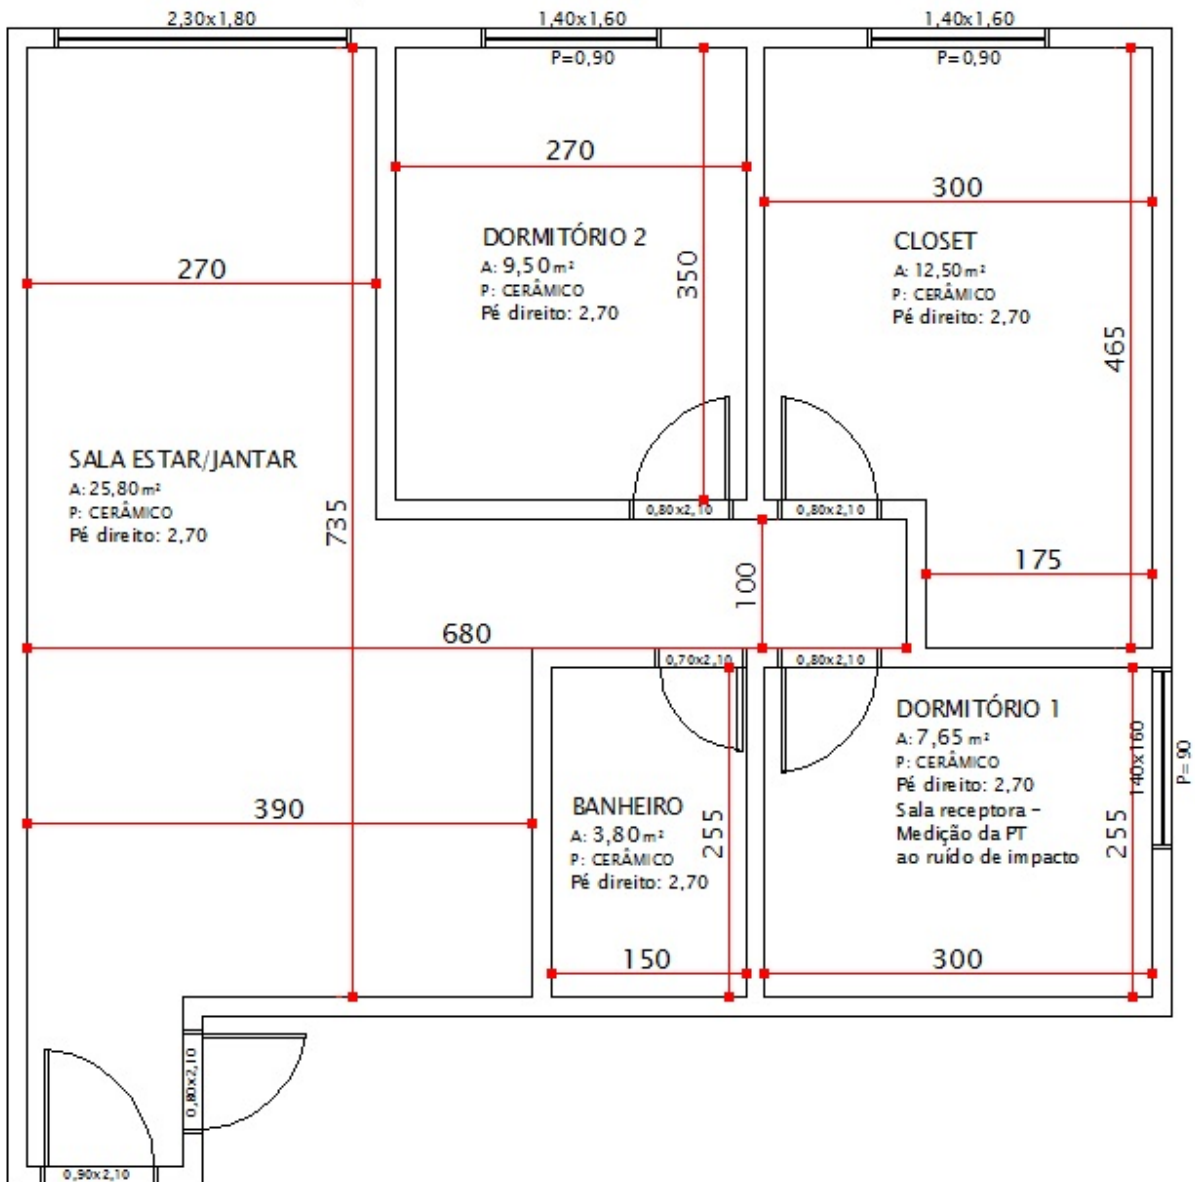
Planta baixa - pavimento superior - 05-R8-N-PC
